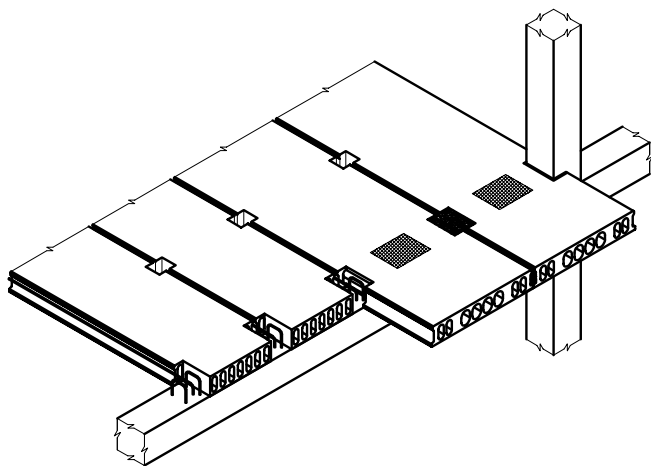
Плита пустотная с многопустотными усилителями в каркасном здании
